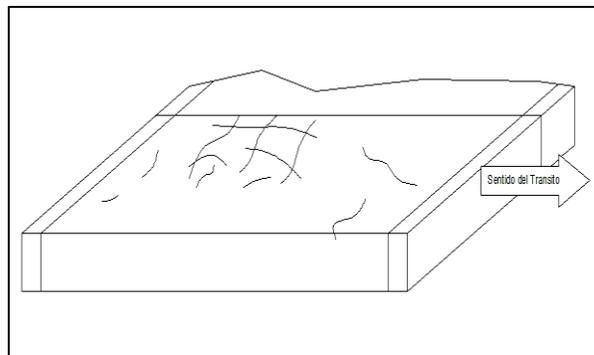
Esquema de fisuramiento por retracción (Autor, 2013).
